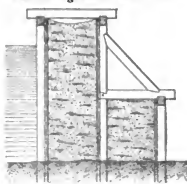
Doppelter Kastenfangdamm. M. 1 : 200.
